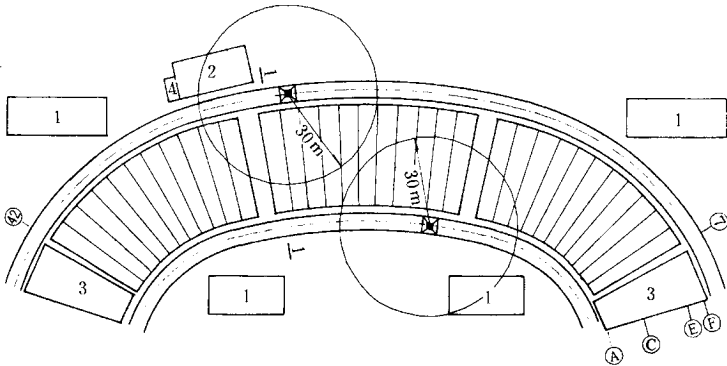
挑棚钢结构安装阶段平面布置图（1-1 剖面详见图 7-4-80）
